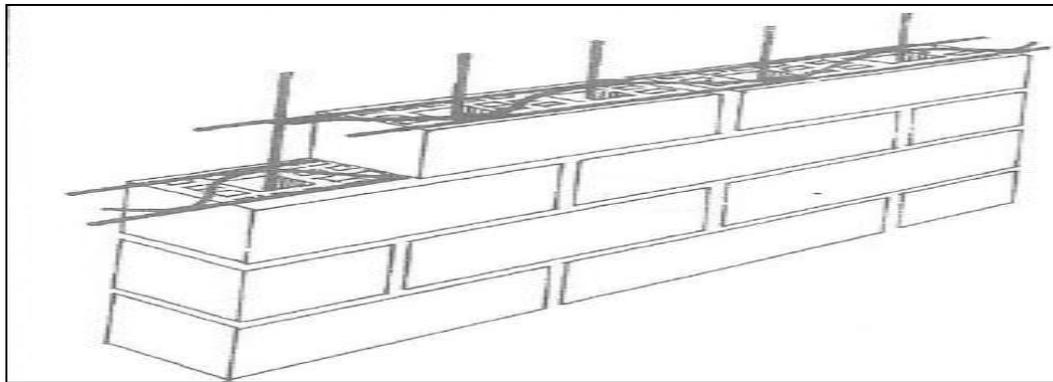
Bloques rectificados en pared (Facincani, 1993).
